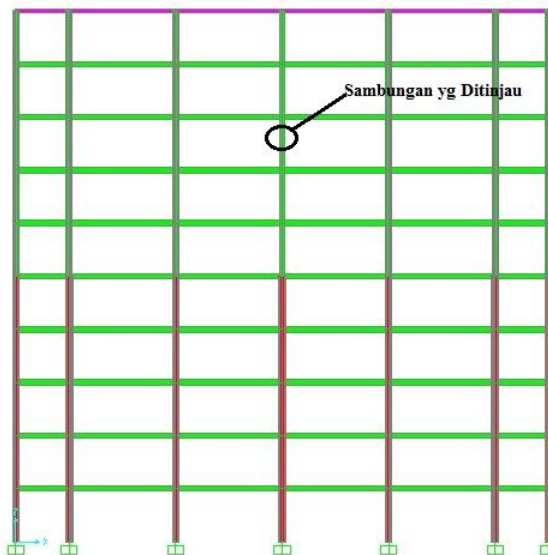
Detail sambungan balok indukt.2-10 – kolom
